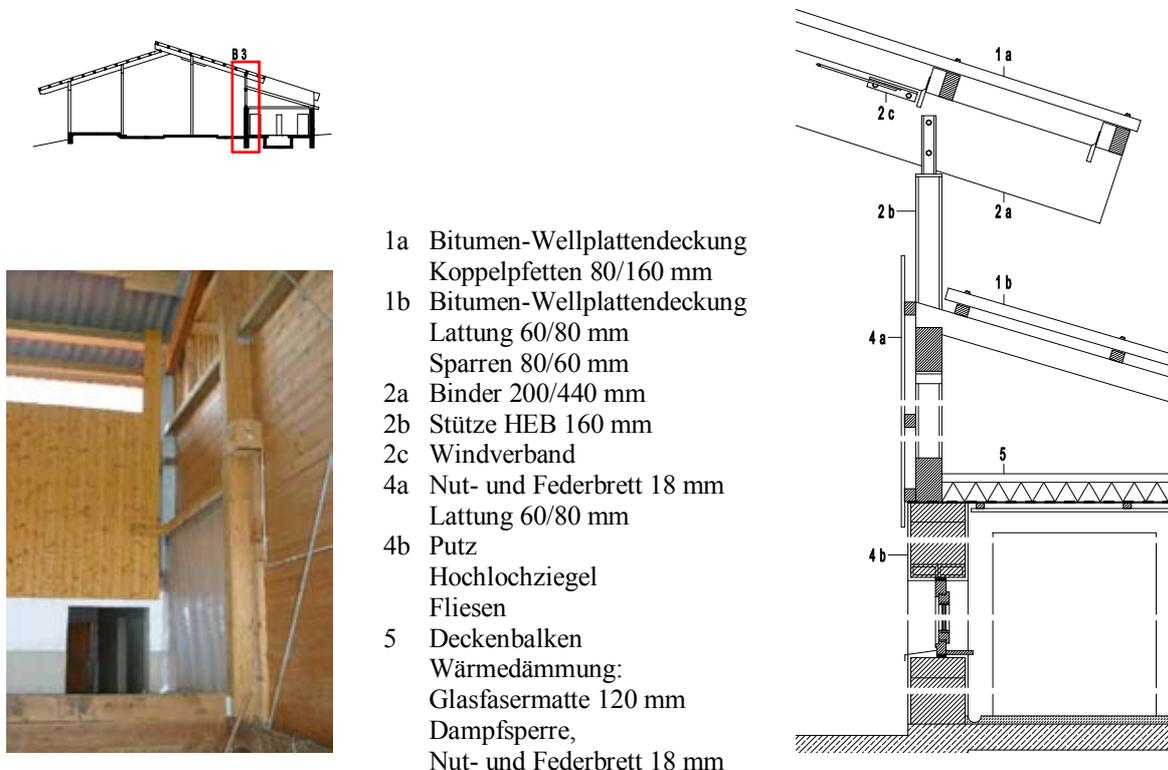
Analyse des Wandaufbaus zwischen Stallgebäude und Melkhaus mit Mängeln in der baulich-technischen Ausführung
